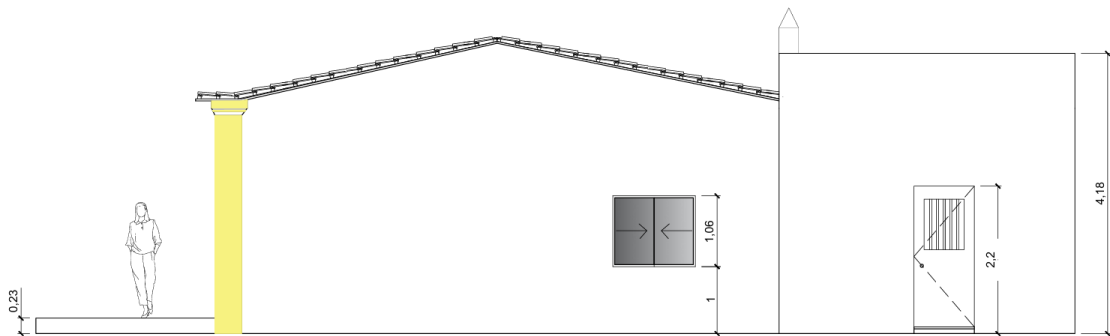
Alçado frontal existente (Fonte: Rita Giro, 2025)
